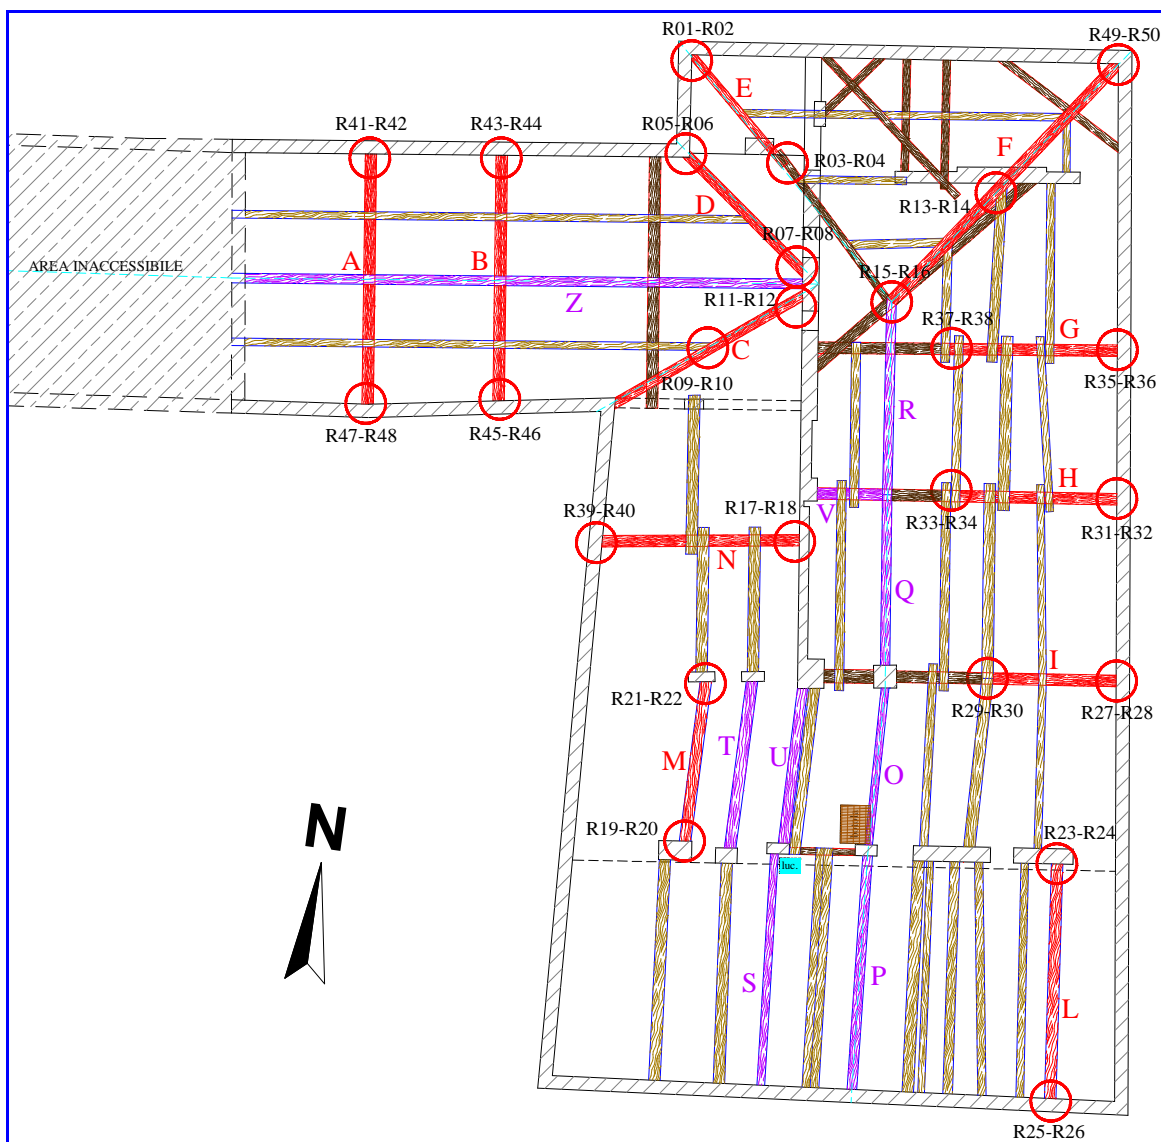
Planimetria piano sottotetto con ubicazione prove
